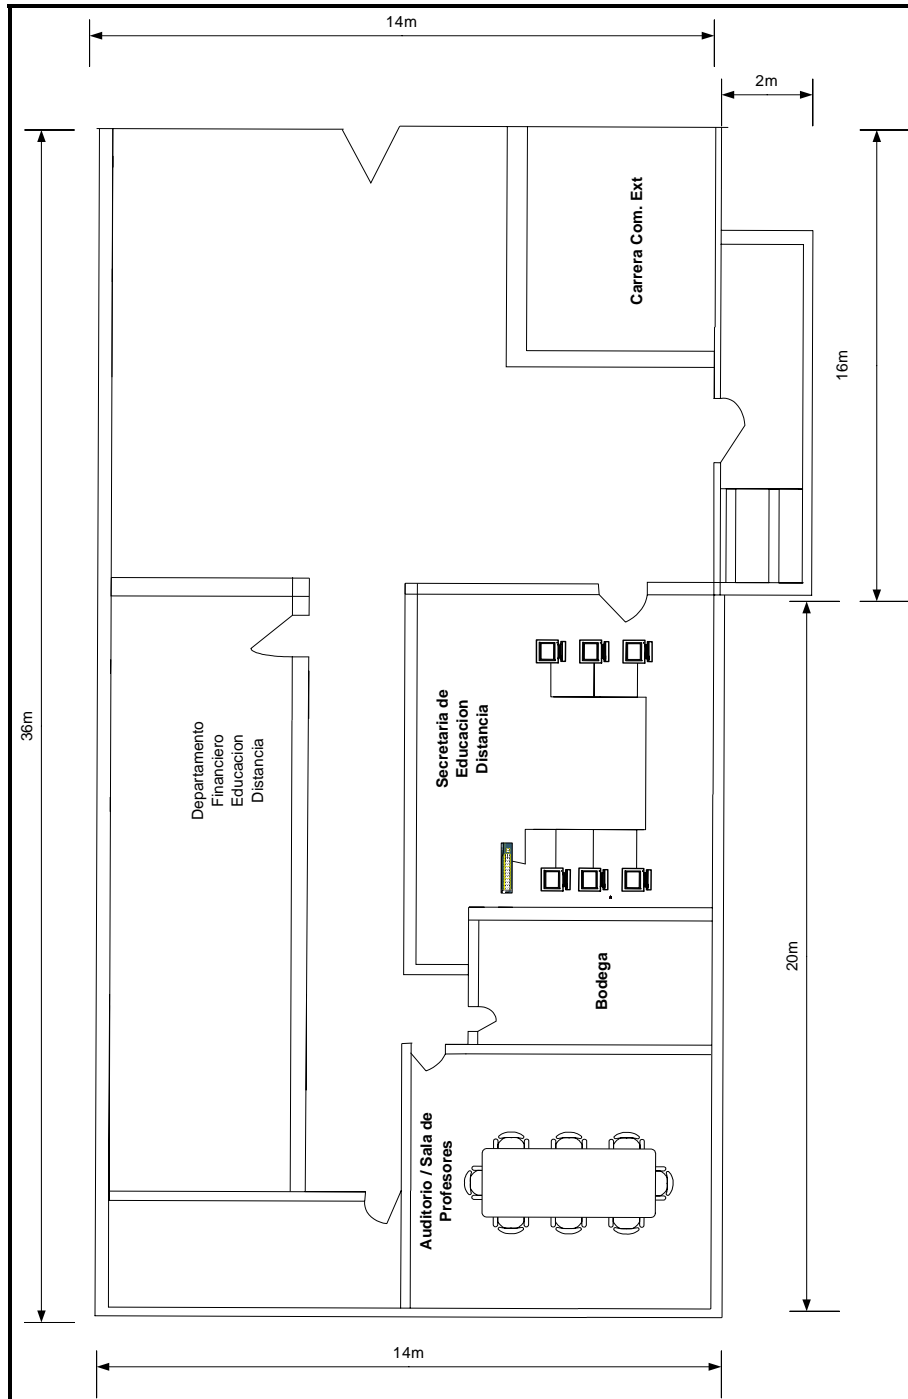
Plano Digital Plana Baja - Edificio Comercio Exterior
